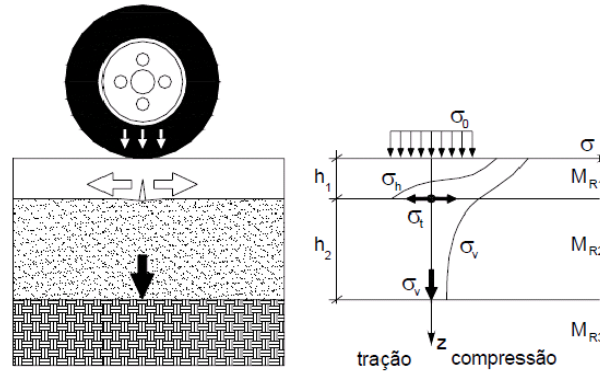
Demonstração do trincamento de um pavimento
